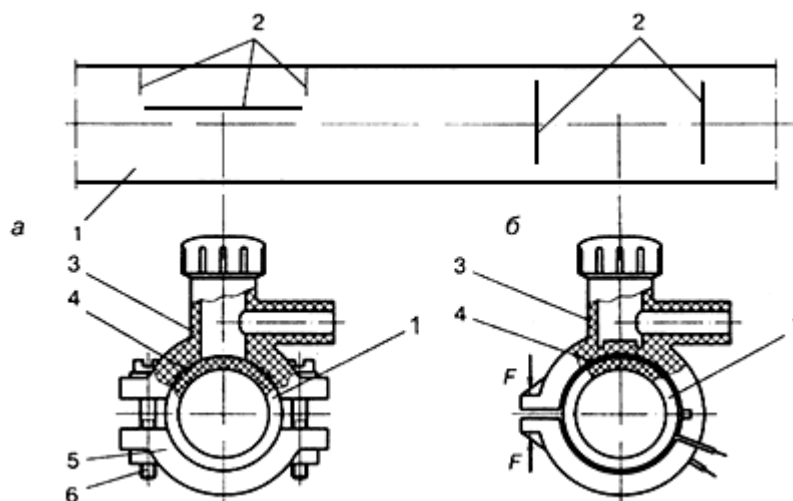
Соединение полиэтиленовой трубы и отводов с закладными нагревателями:
